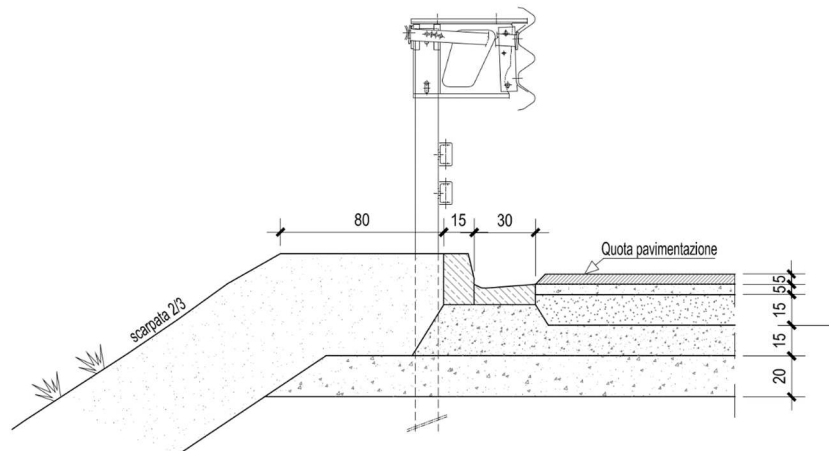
Sezione stradale in rettilineo – cunetta alla francese con scarico in pozzetti prefabbricati
